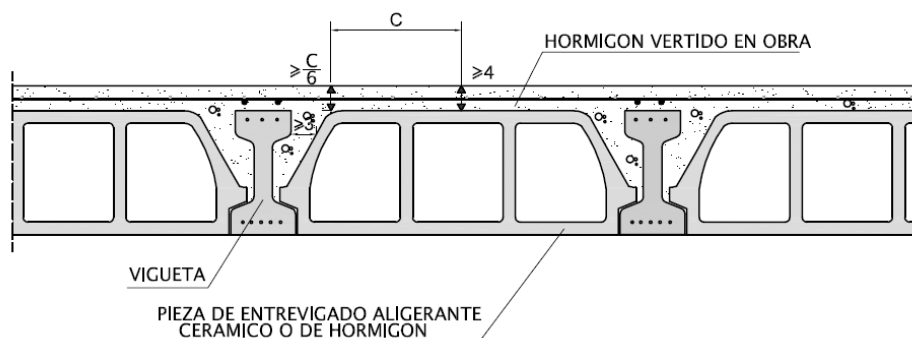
Sección tipo de forjado sanitario con viguetas pretensadas doble T
